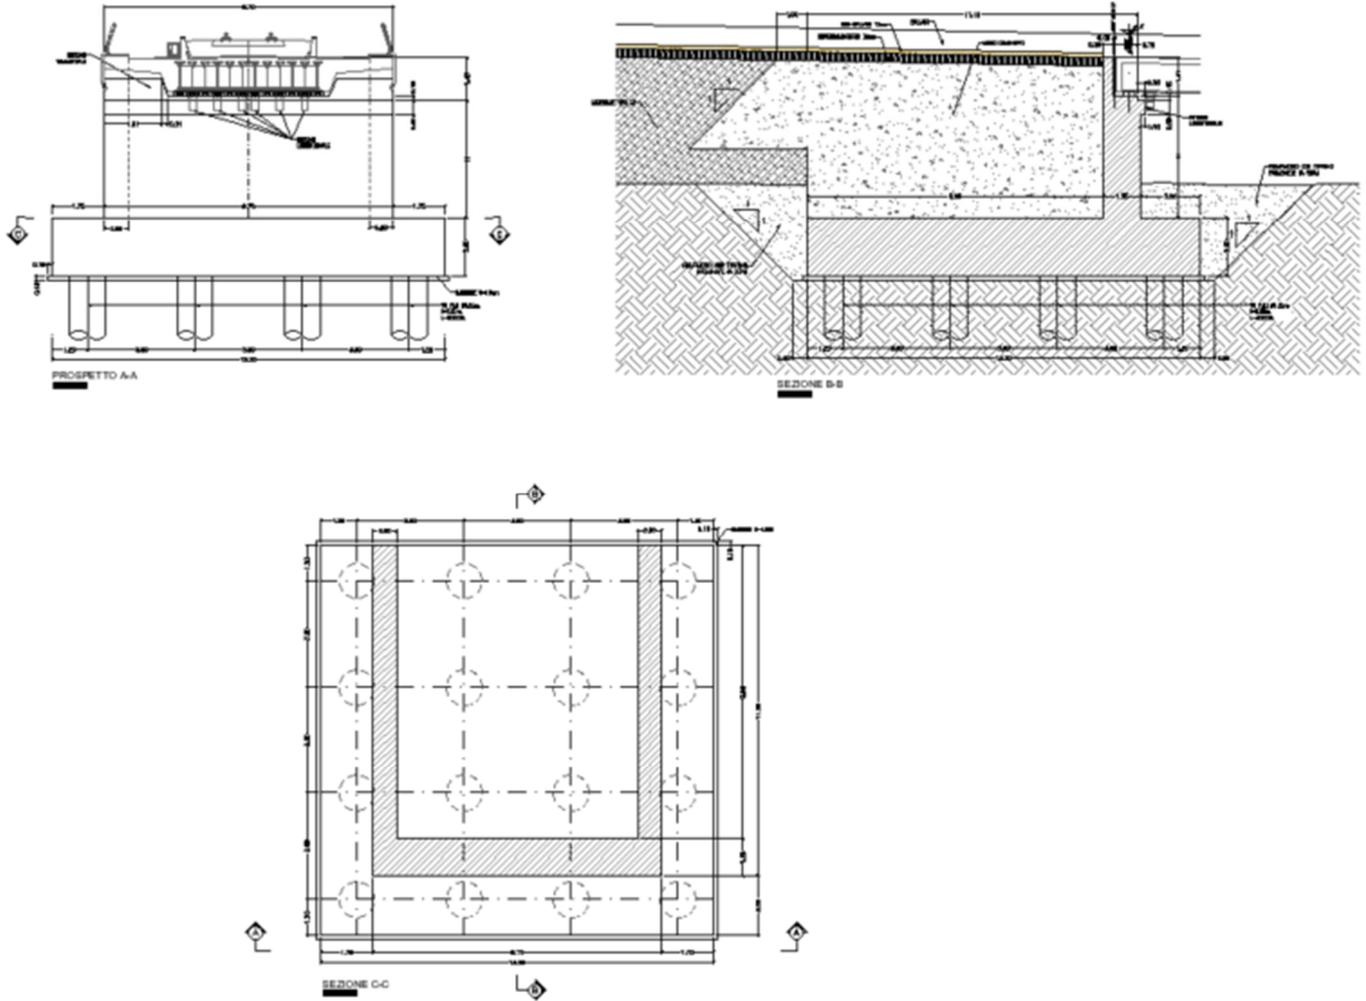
Prospetto e sezioni spalle VI02 [m]
